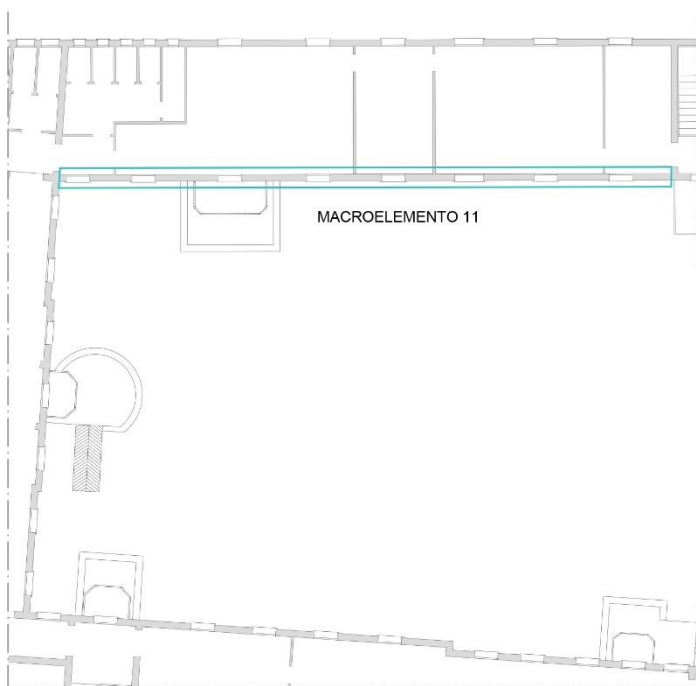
Individuazione del macroelemento in prospetto e pianta
